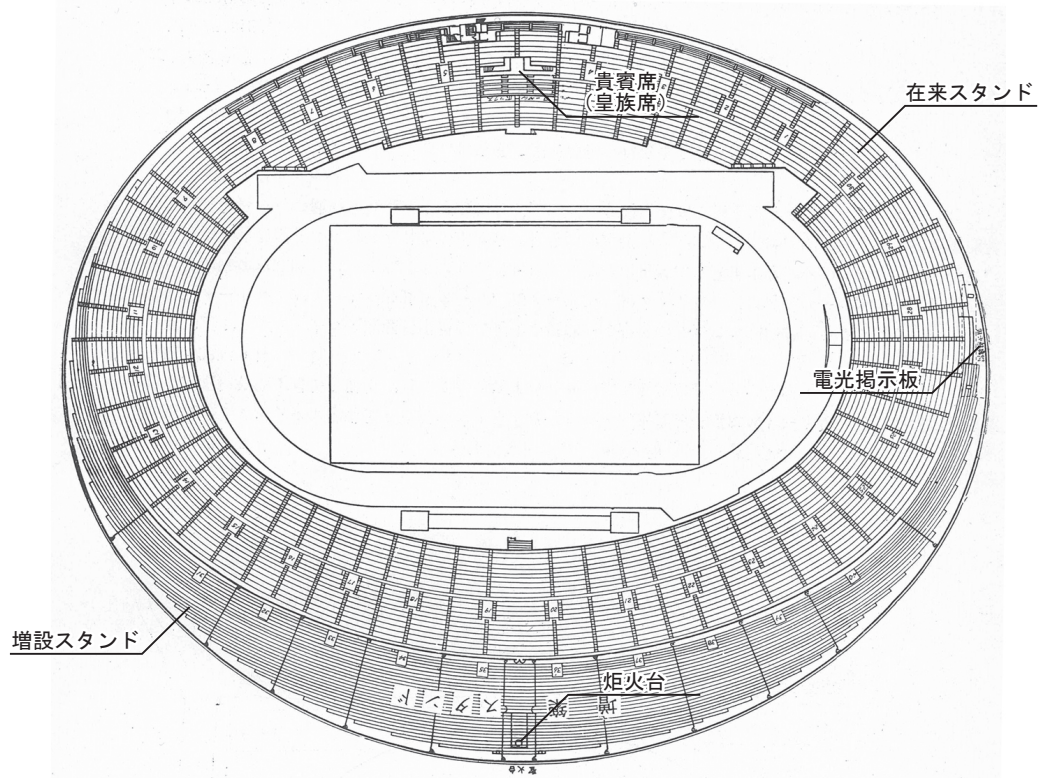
スタンド増築後の国立霞ヶ丘陸上競技場 スタンド平面図
